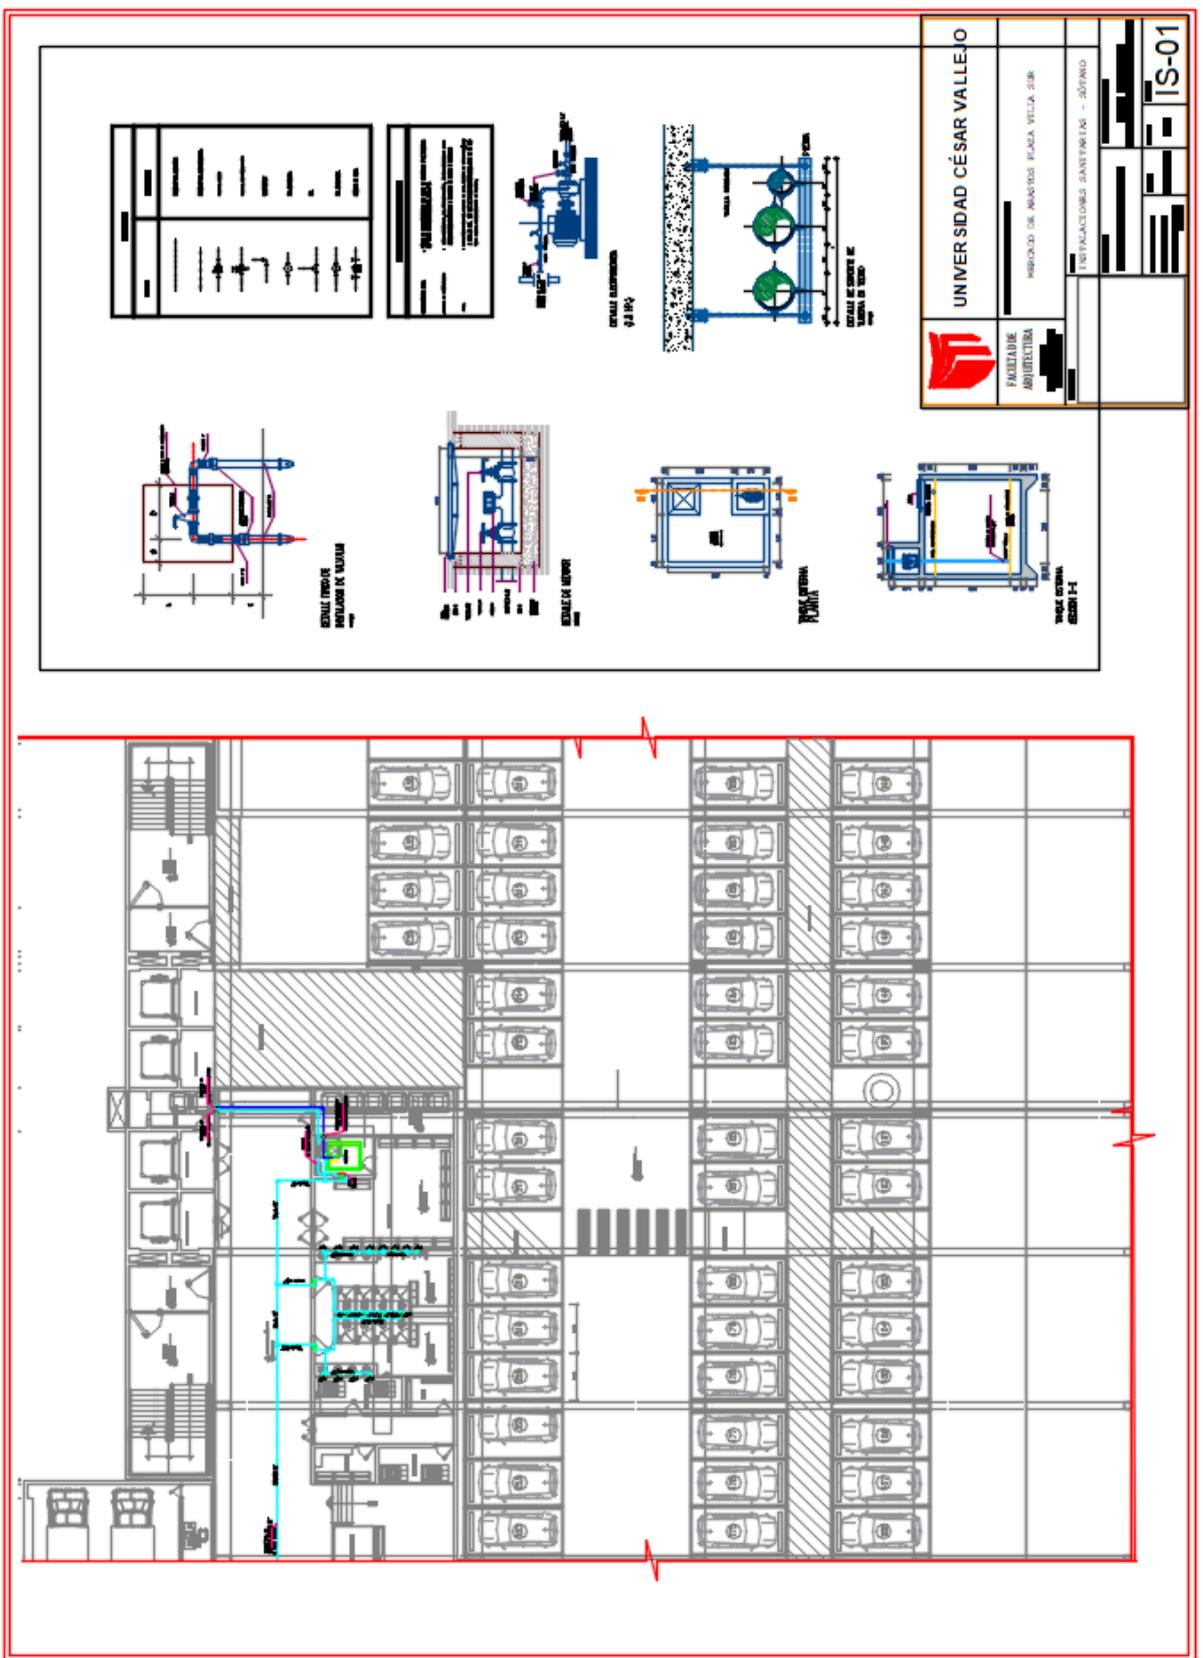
Plano de Sanitarias – Plano de instalaciones de Agua sótano.
